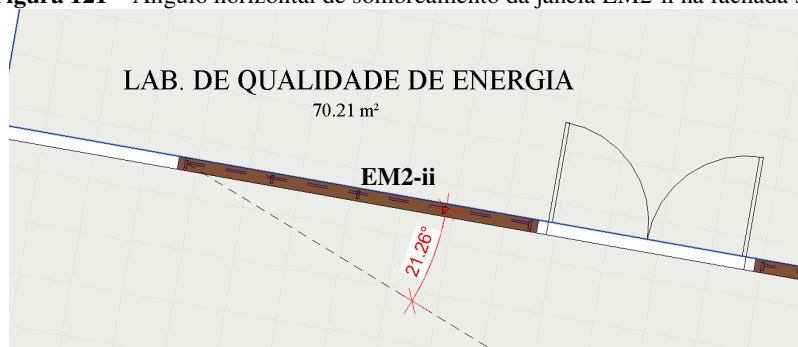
Ângulo horizontal de sombreamento da janela EM2-ii na fachada sul
